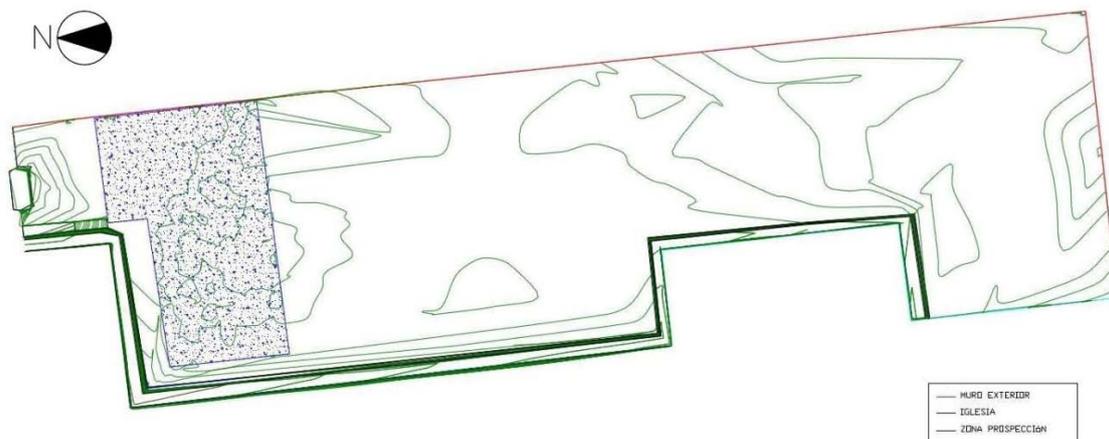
Planta general del patio del cementerio parroquial con la zona de microtopografía (en azul)
